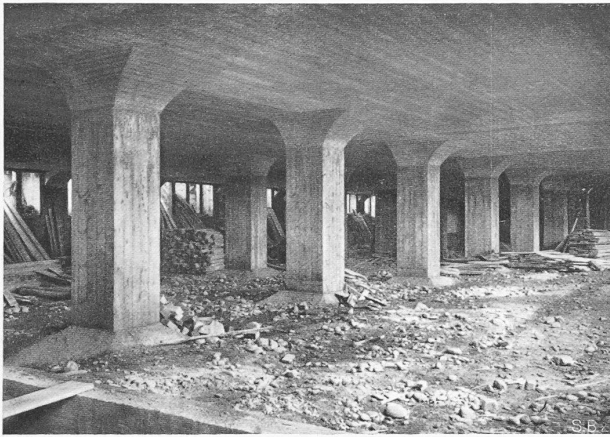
Pilldecke im Untergeschoss (Hauptbau).
